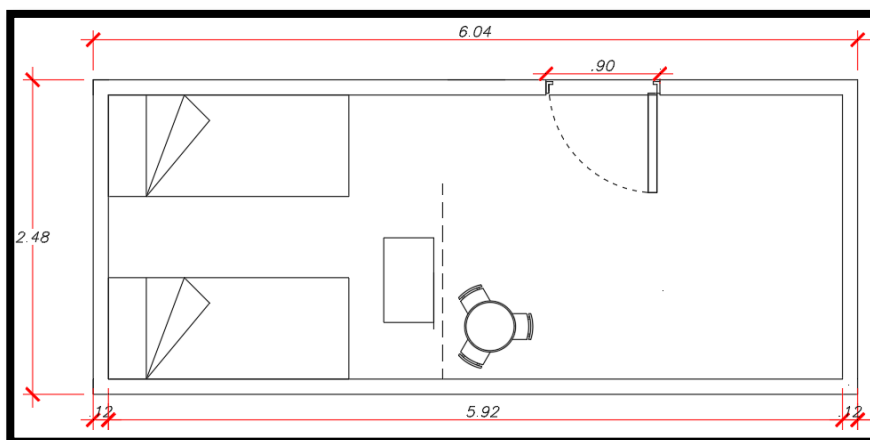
Distribución Módulo Temporal Tipo "A"- Vista Planta
